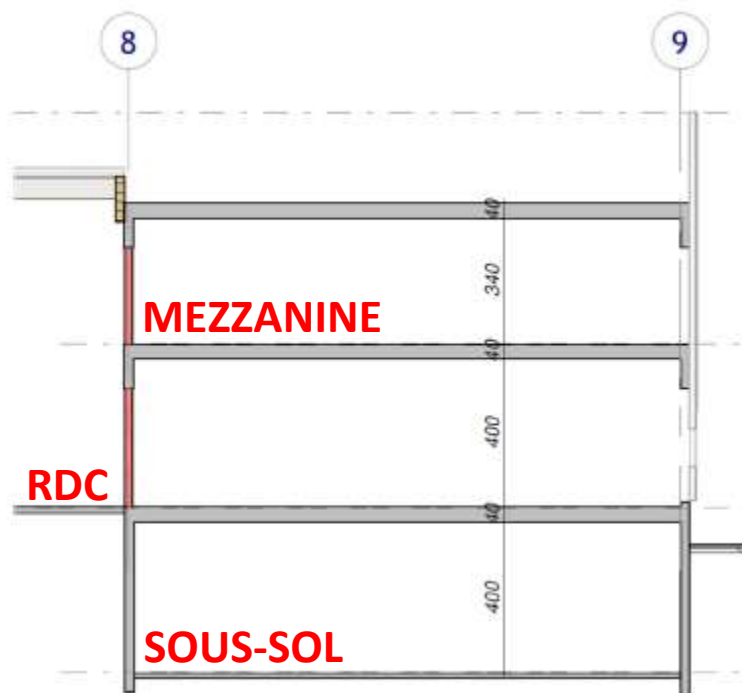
PLAN DE COUPE ENTRE LES FILES 8 ET 9 PERMETTANT DE VISUALISER LES DALLES BETON
